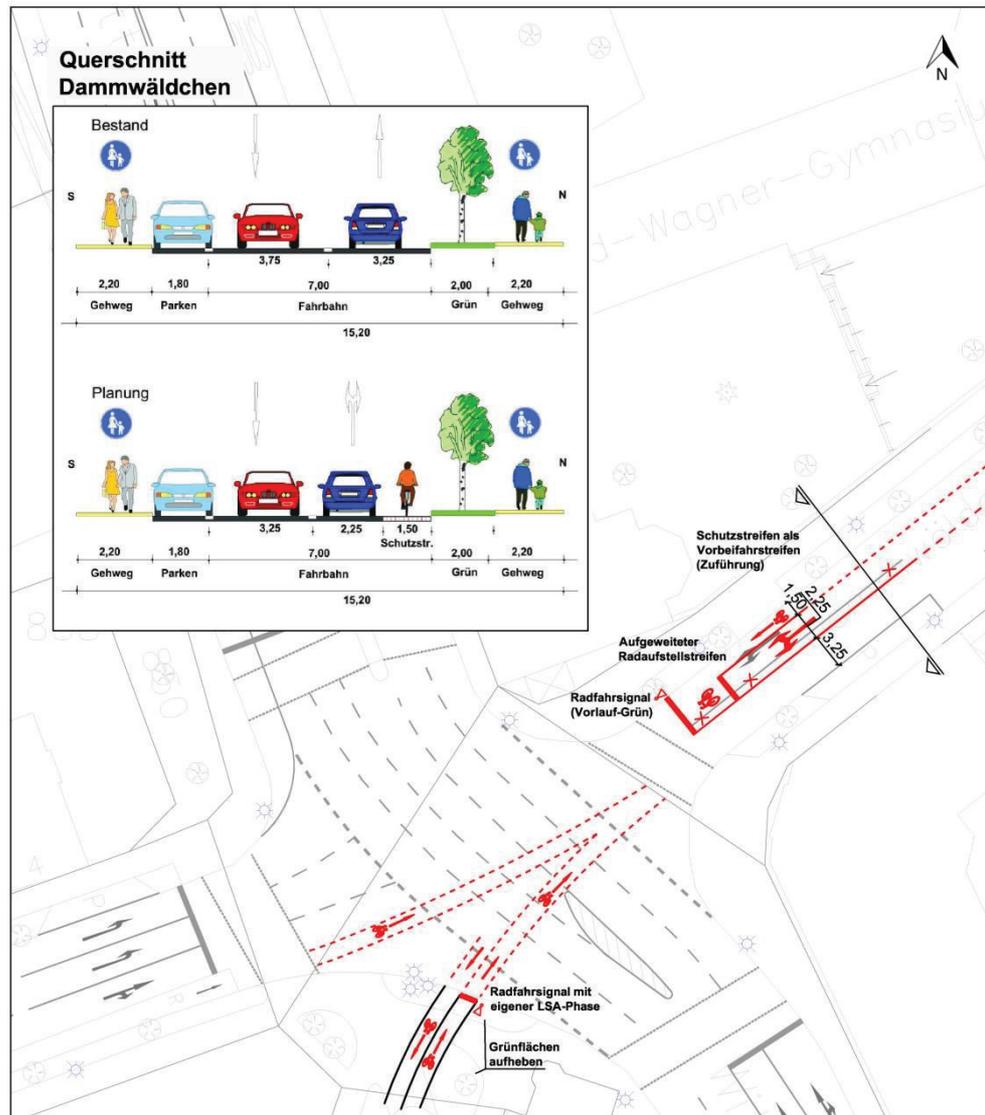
Lageplan- und Querschnittsskizze Knotenpunkt Wittelsbacherring/ Bismarckstraße/ Dammwäldchen (PGV) (vgl. Q3)
